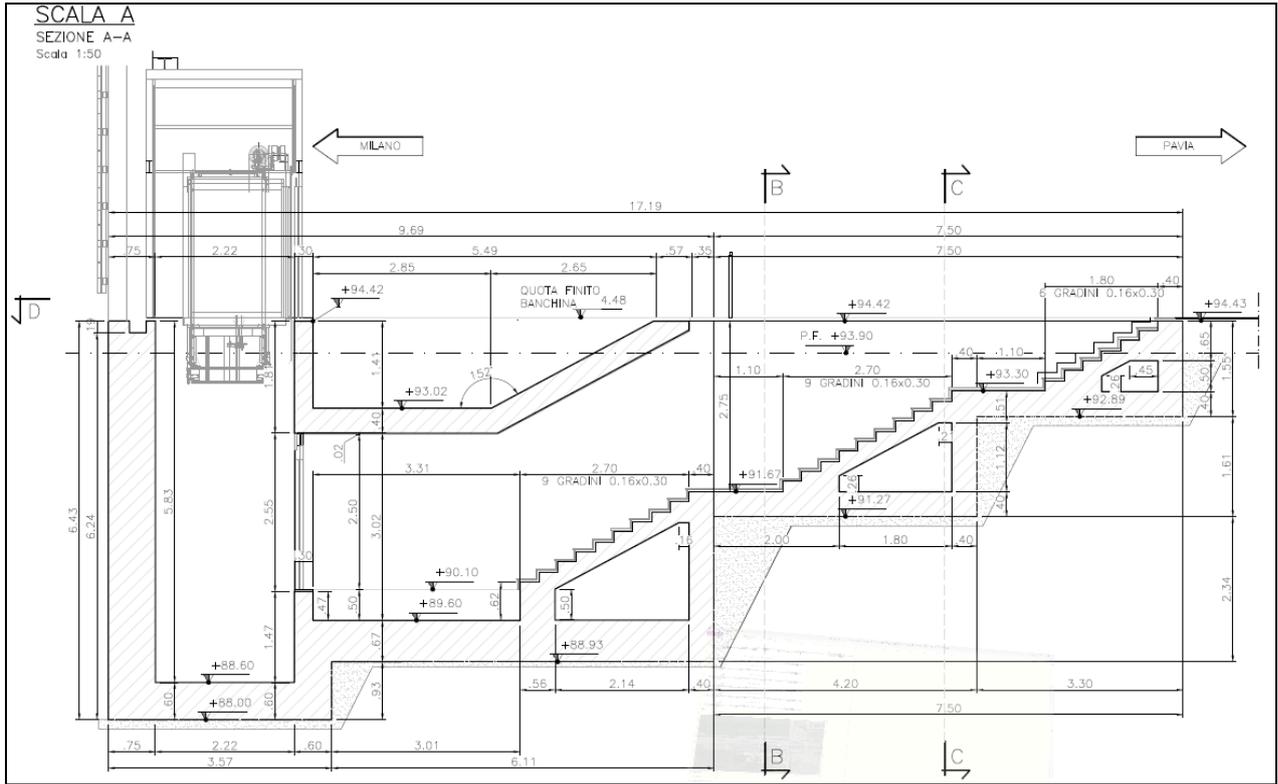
Sezione nuove scale di accesso al 3° marciapiede.
